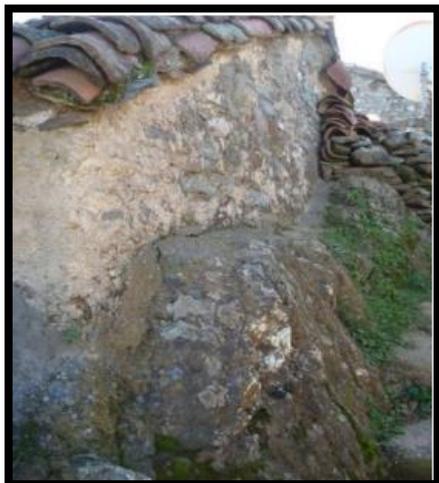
murs sur un bloc de pierre du village Ait-Daoud Beni-Yenni.
